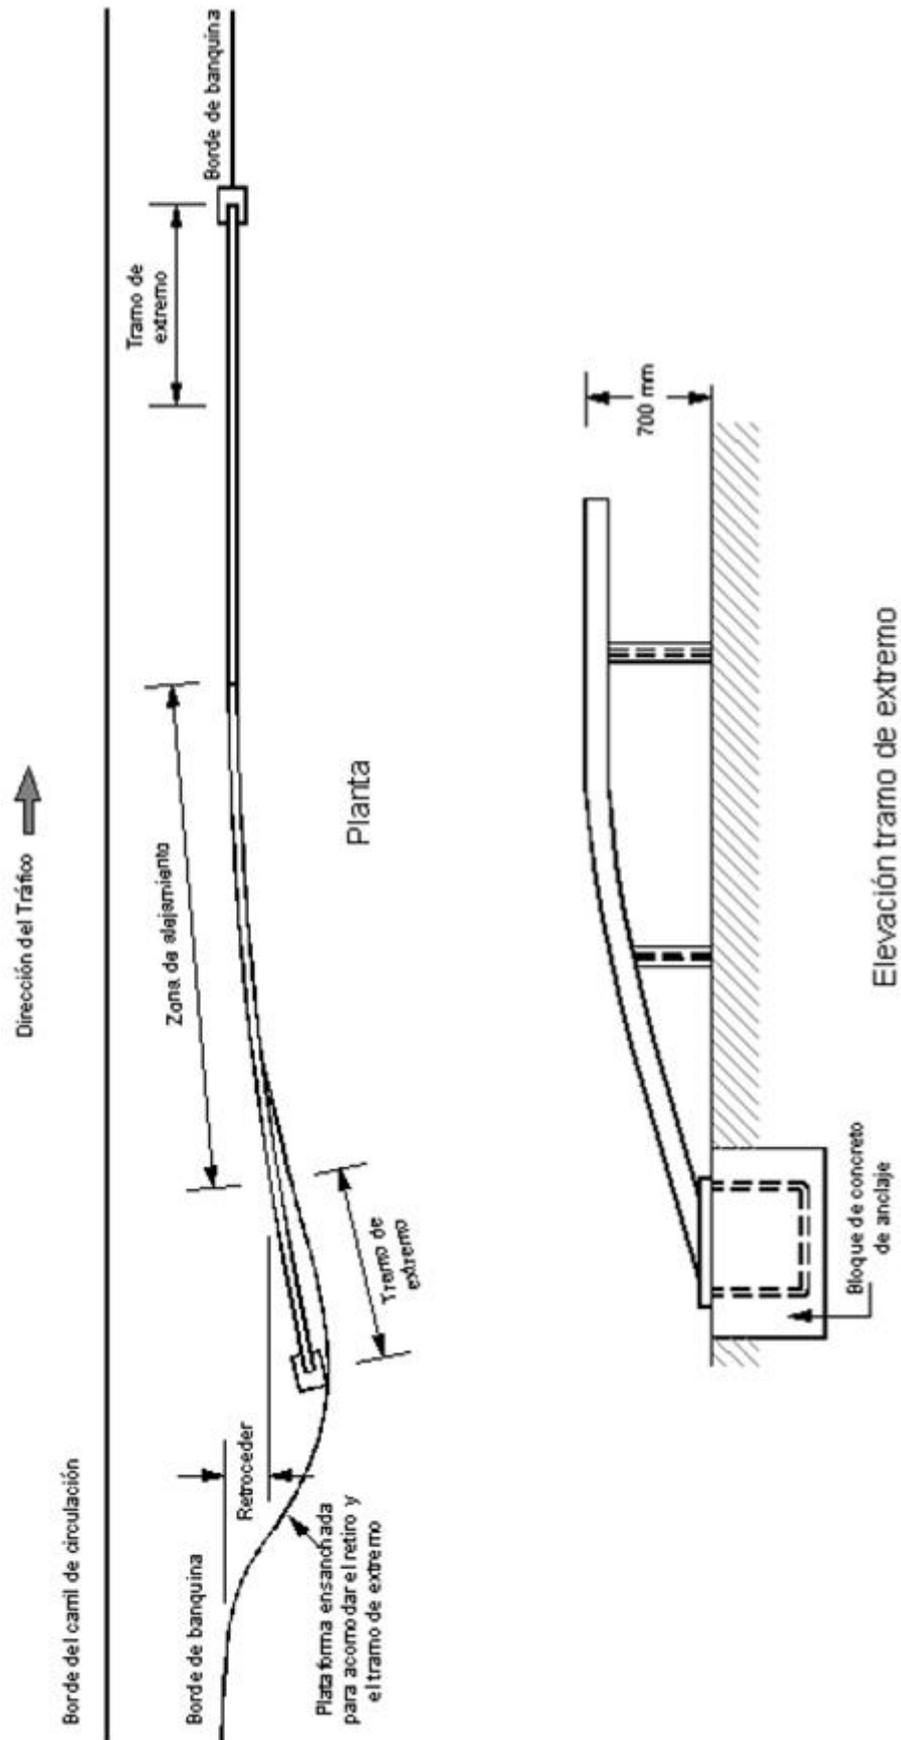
TRATAMIENTO DEL EXTREMO DE LA BARRERA DE VIGA CAJÓN
